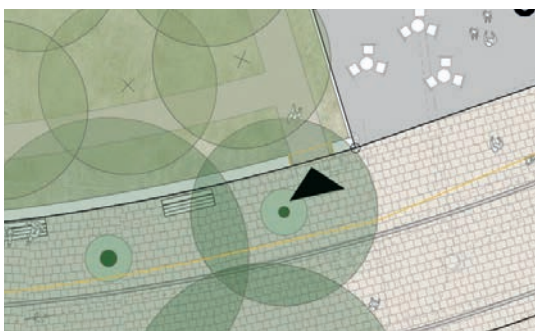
Ausschnitt Situationsplan Richtprojekt, Schlosshof
